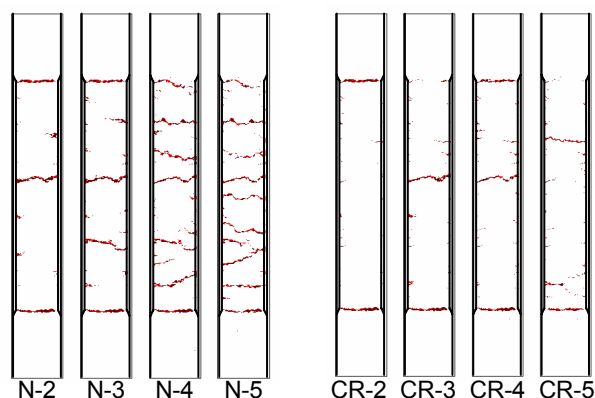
ひび割れ図 (N ケース, CR ケース)
